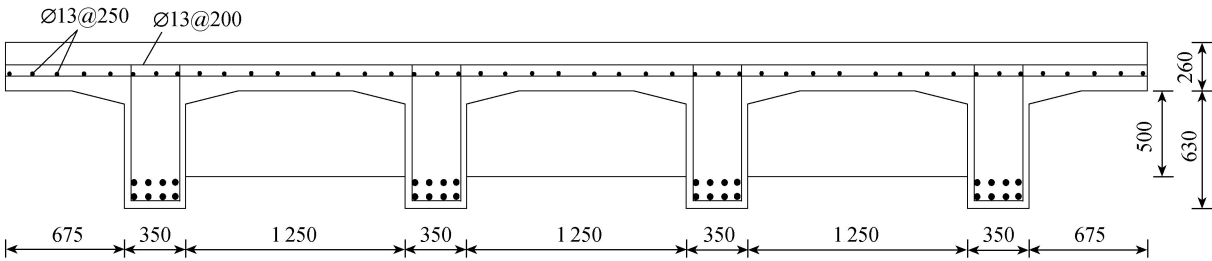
钢筋混凝土多梁式 T 梁构造(单位:mm)
